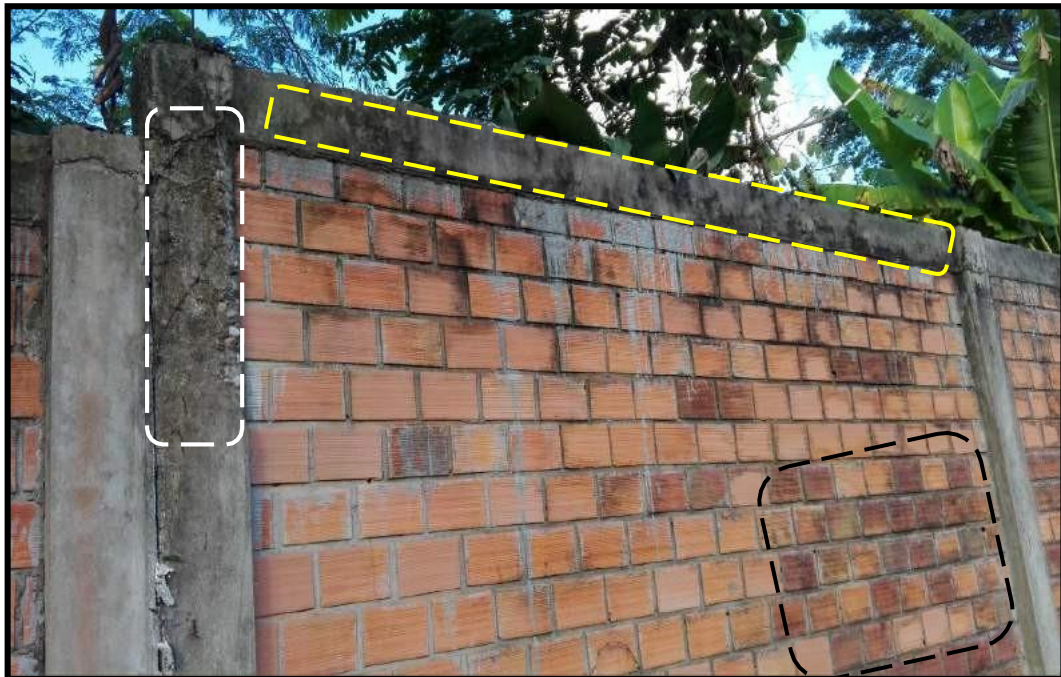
Se aprecia desintegración en columna y eflorescencia en viga y muro.
